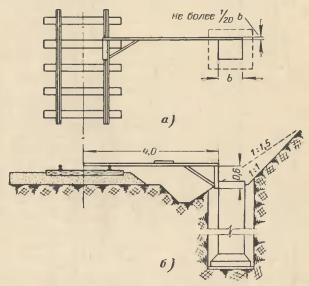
Шаблон-рейка для проверки габарита устанавливаемого фундамента. a- план; 6- разрез.
